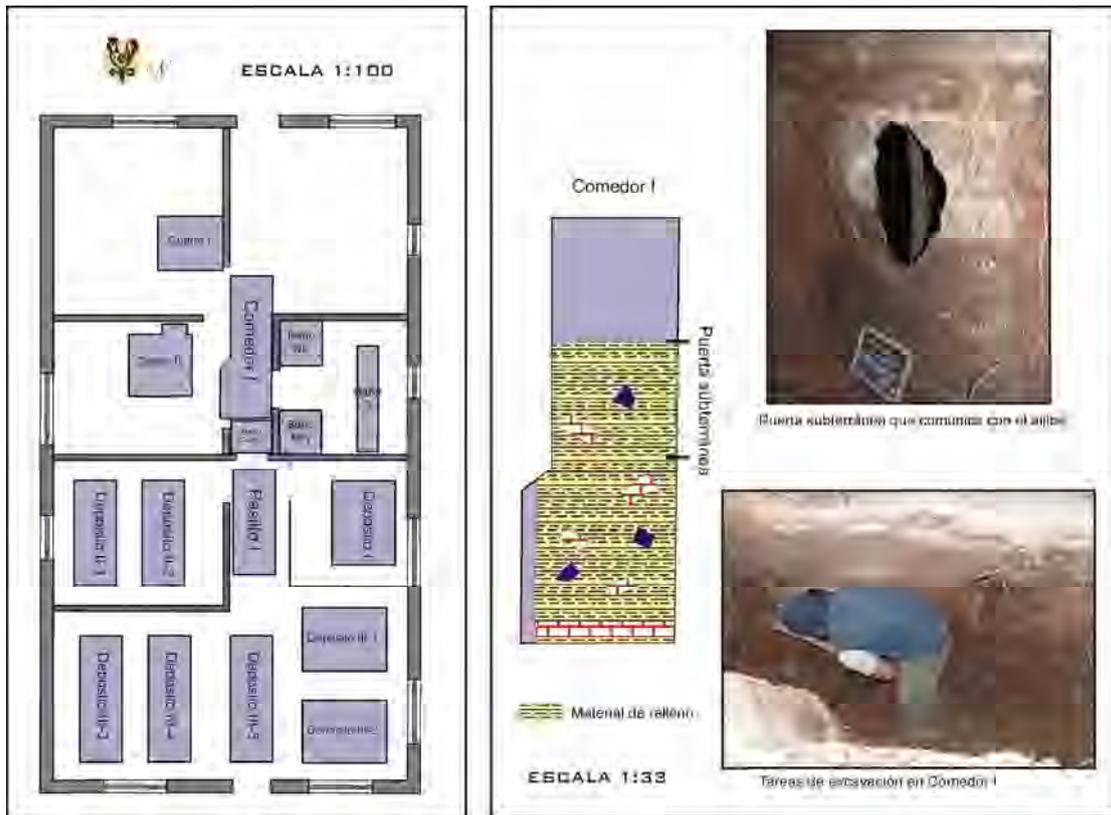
Plano de planta de las intervenciones efectuadas en la casa (izq.) y detalle de la excavación Comedor I (der.)
